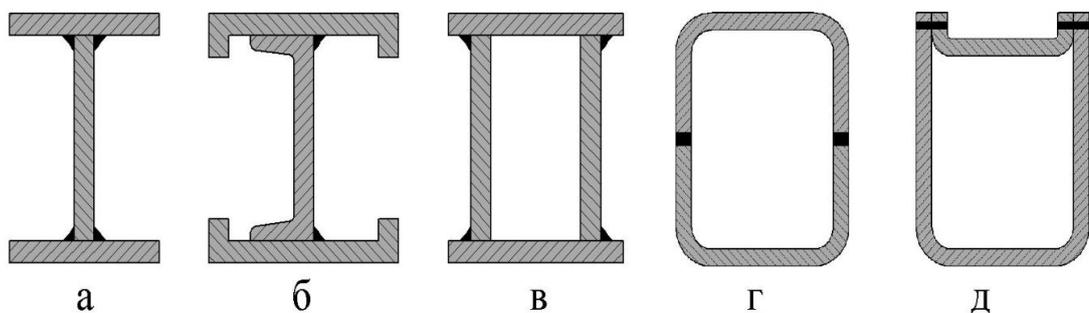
Варианты сварных двутавровых и коробчатых балок:
